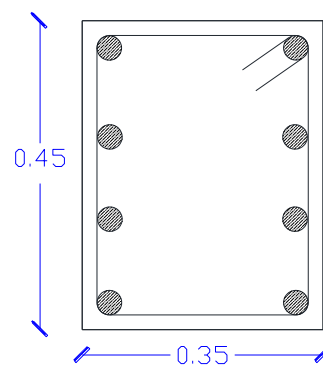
Detalle de distribución de acero en la sección de la columna (Estructura 1).
